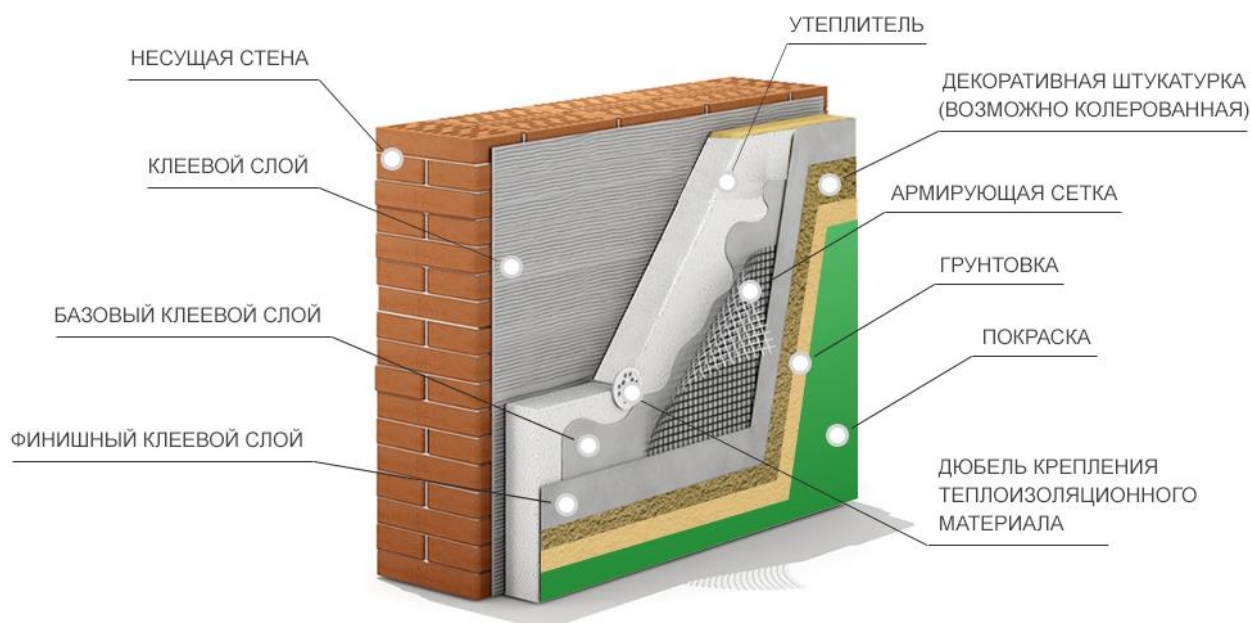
Конструкция системы утепления «Мокрый фасад»
